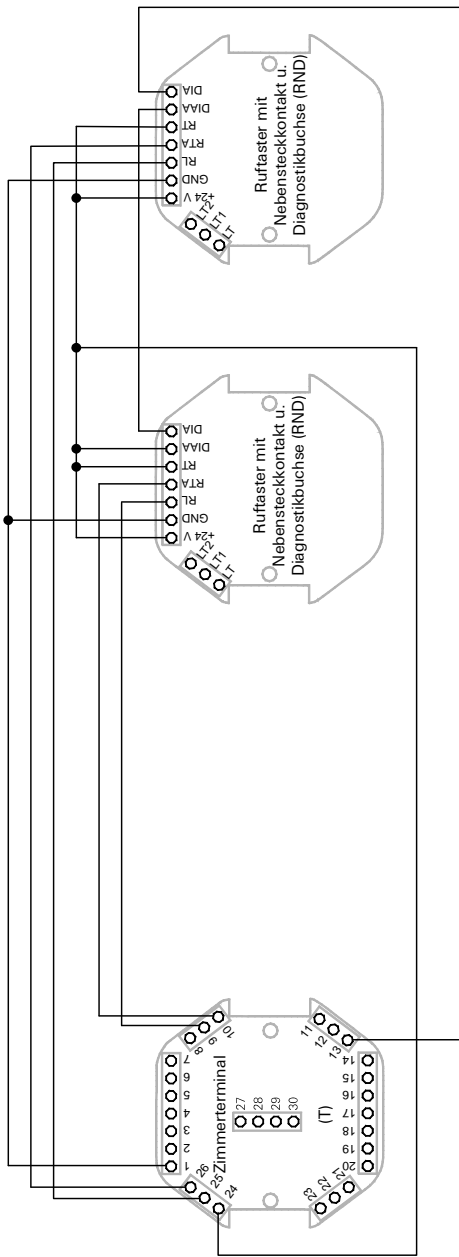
Verdrahtung in einem Zweibettzimmer mit RAN, RT und T mit Bettenkennung (Beispiel 2)
